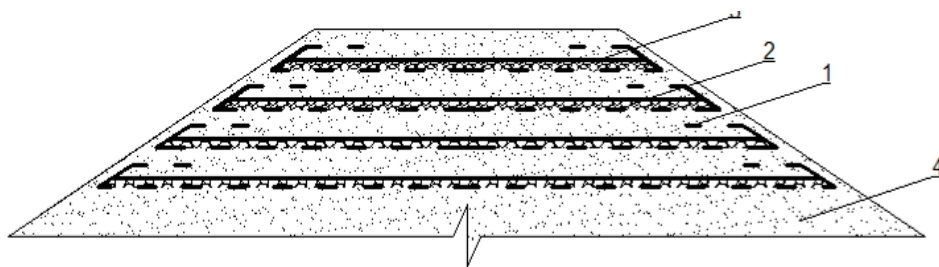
Армированная гребневая часть грунтовой плотины: 1 - георешётка; 2 - местный грунт; 3 - геотекстиль, 4 – тело грунтовой плотины
